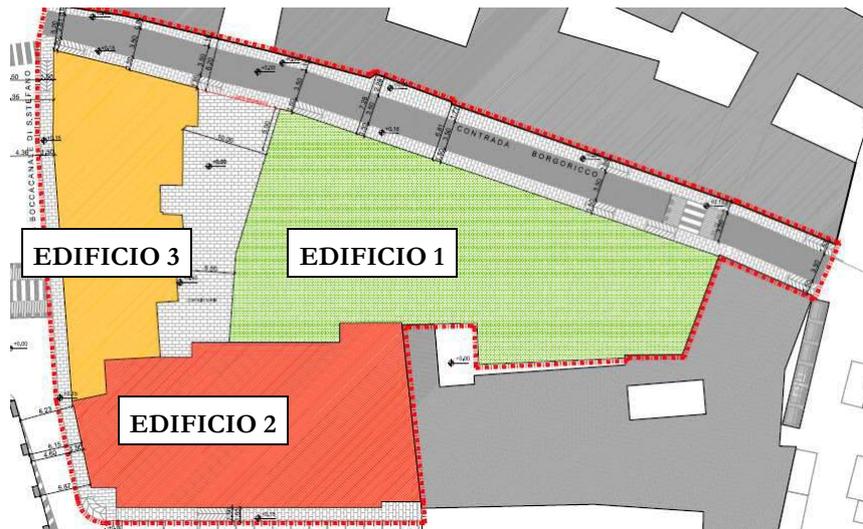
Individuazione dei tre edifici oggetto di intervento
